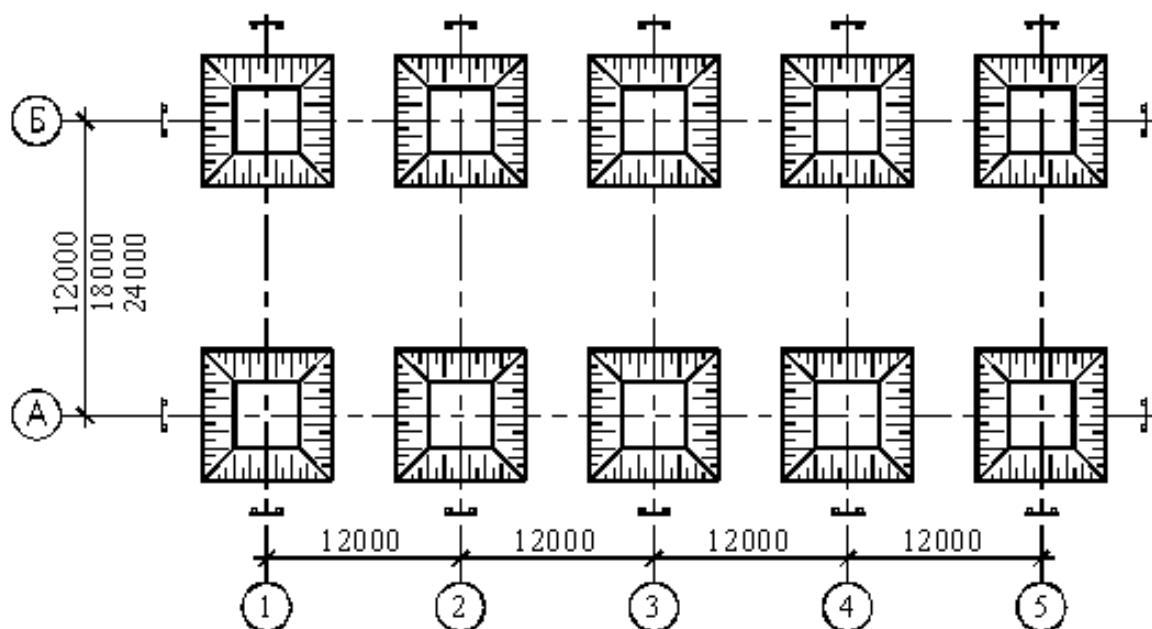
Схема устройства котлованов при шаге и пролете колонн 12 м и более
